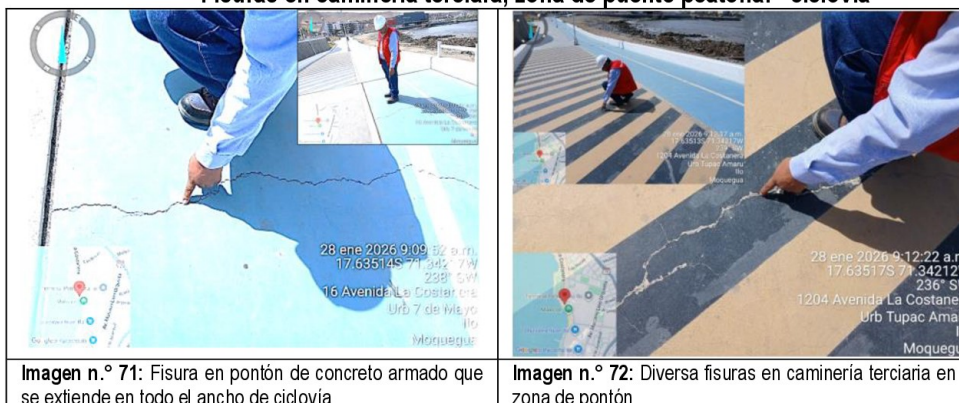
Fisura en pontón de concreto armado que se extiende en todo el ancho de ciclovia.
